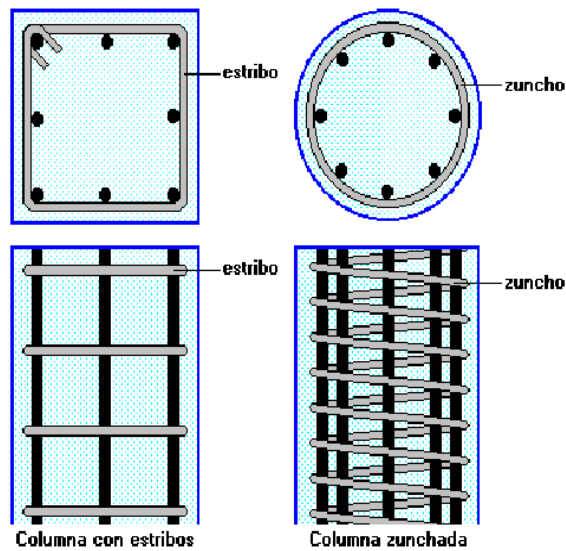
Columnas de hormigón armado con estribos y zunchadas.
